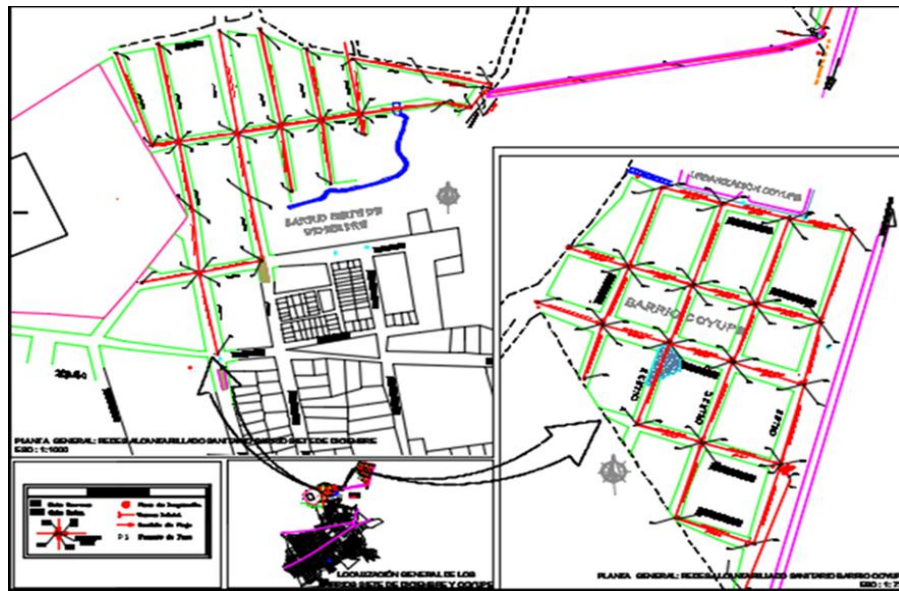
Planta general red de alcantarillado sanitario barrio siete de diciembre y coyupe fuente: unión temporal coyupe 2017
